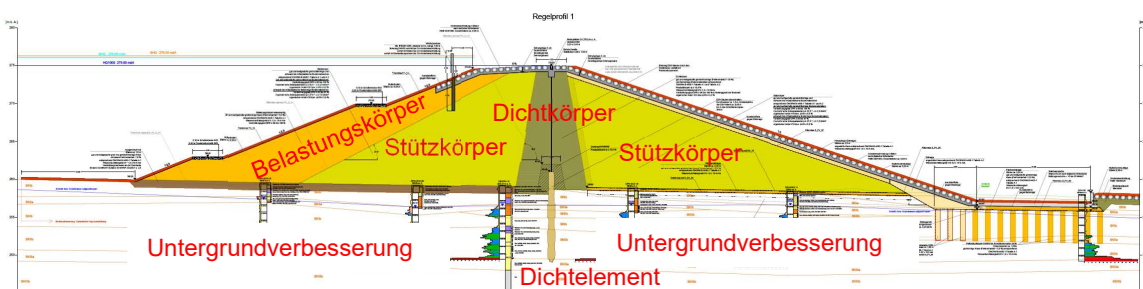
RHB Sirnitzbach, Dammaufbau (Schema, Geotest)
